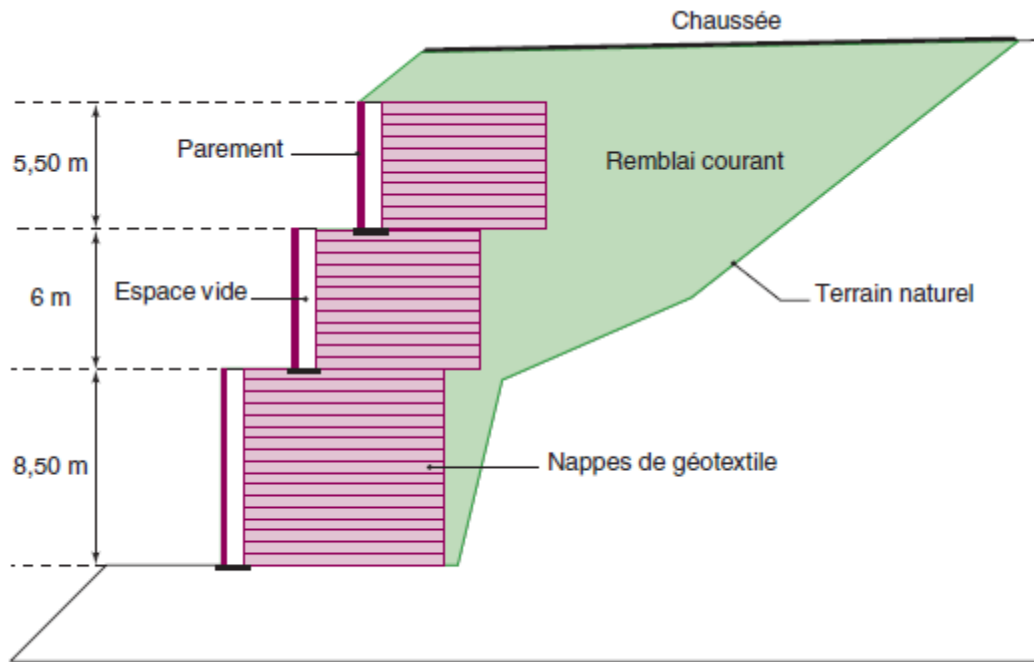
Ouvrage en remblai renforcé par nappes de géotextile à parements verticaux et indépendants.
